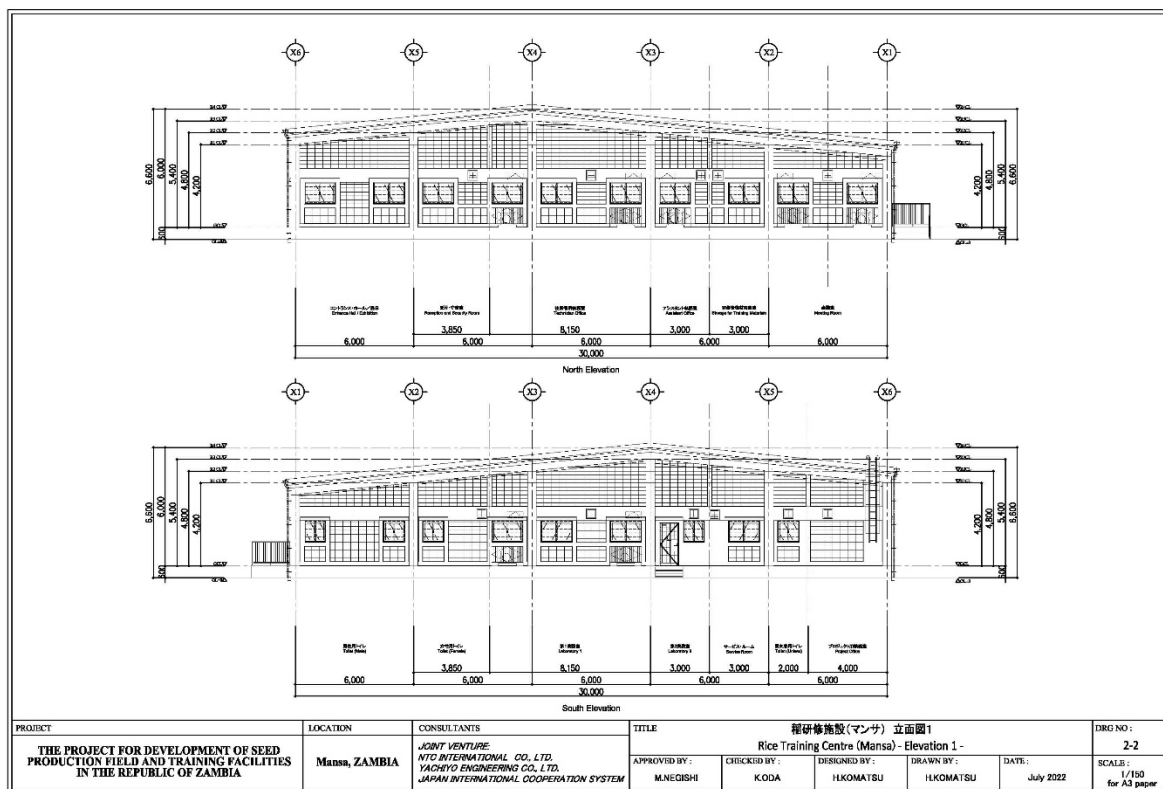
稲研修施設の立面図(マンサ研究所)
